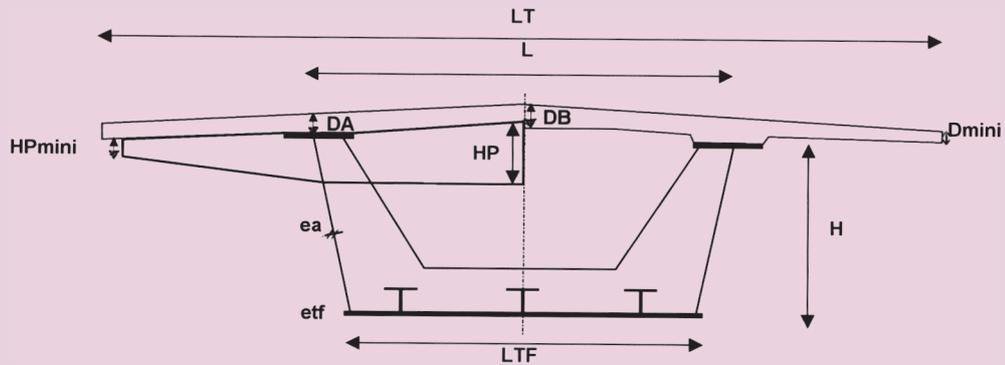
Paramètres du dimensionnement d'un caisson (à gauche, à pièces de pont avec consoles ; à droite, sans pièce de pont)
